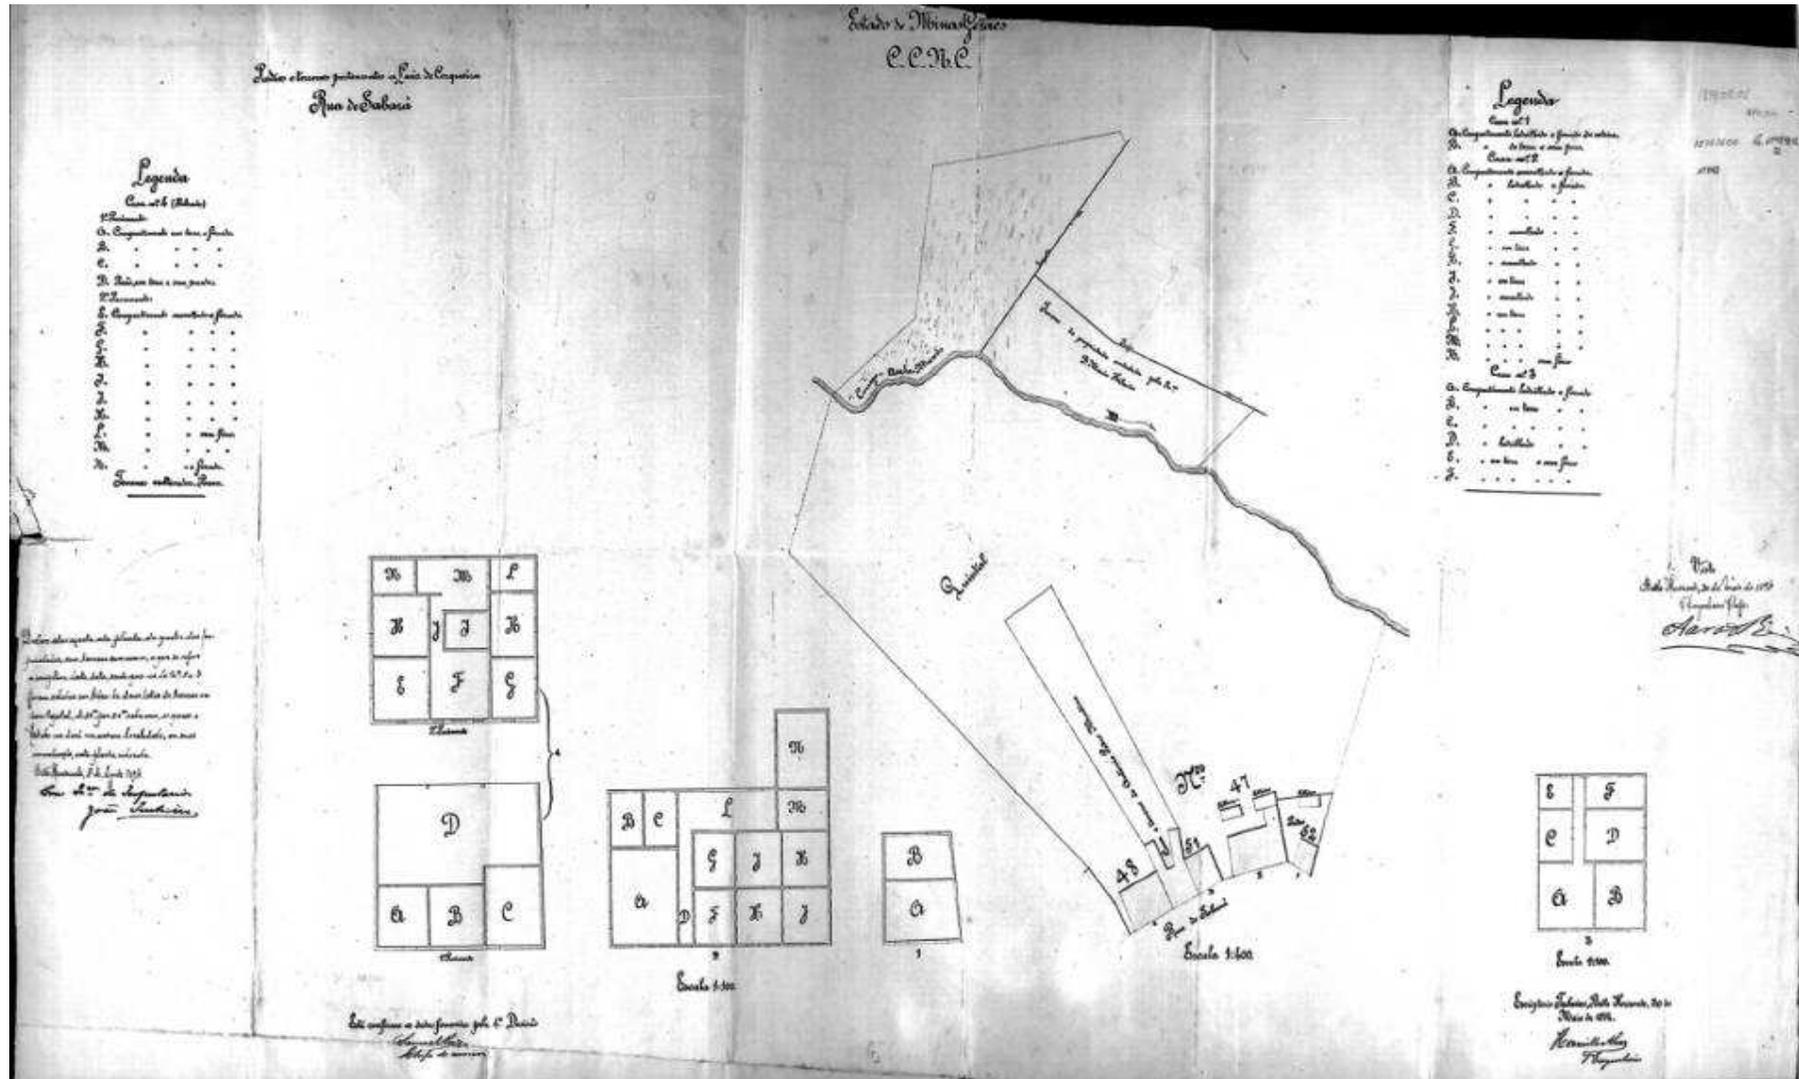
Plantas de prédios e terrenos de Luiz de Cerqueira, Arraial de Belo Horizonte, entre 1894 e 1901.
